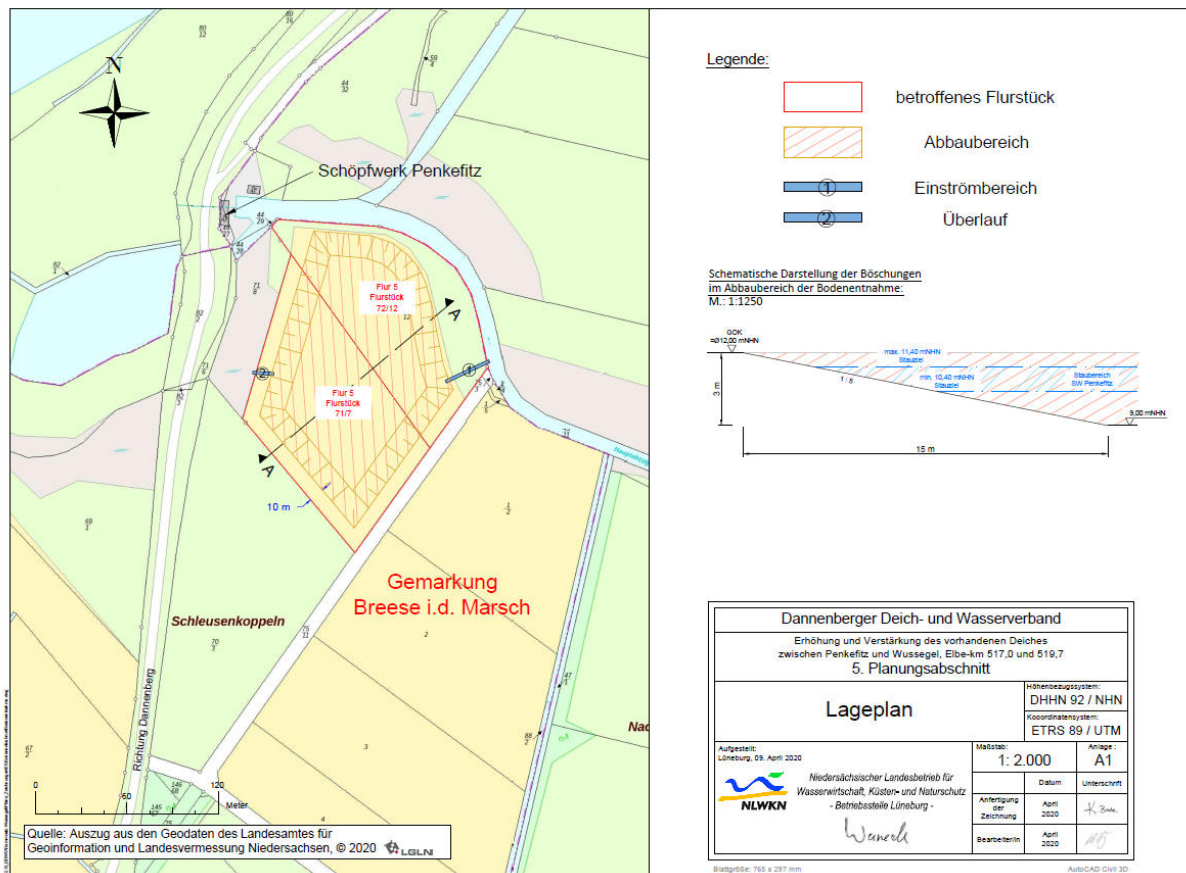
Lageplan der Bodenentnahmestelle 1 für den Planungsabschnitt 5.
